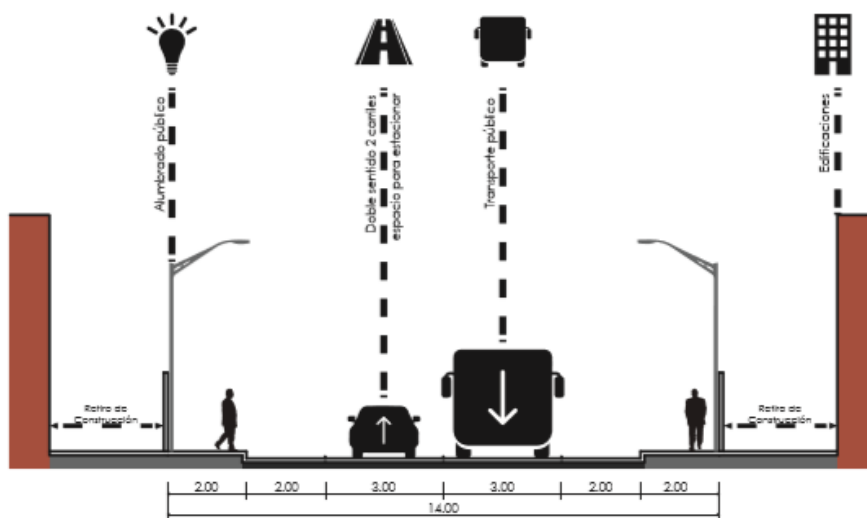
Sección transversal de calle 24 de Mayo, lindero sur del terreno de intervención.
